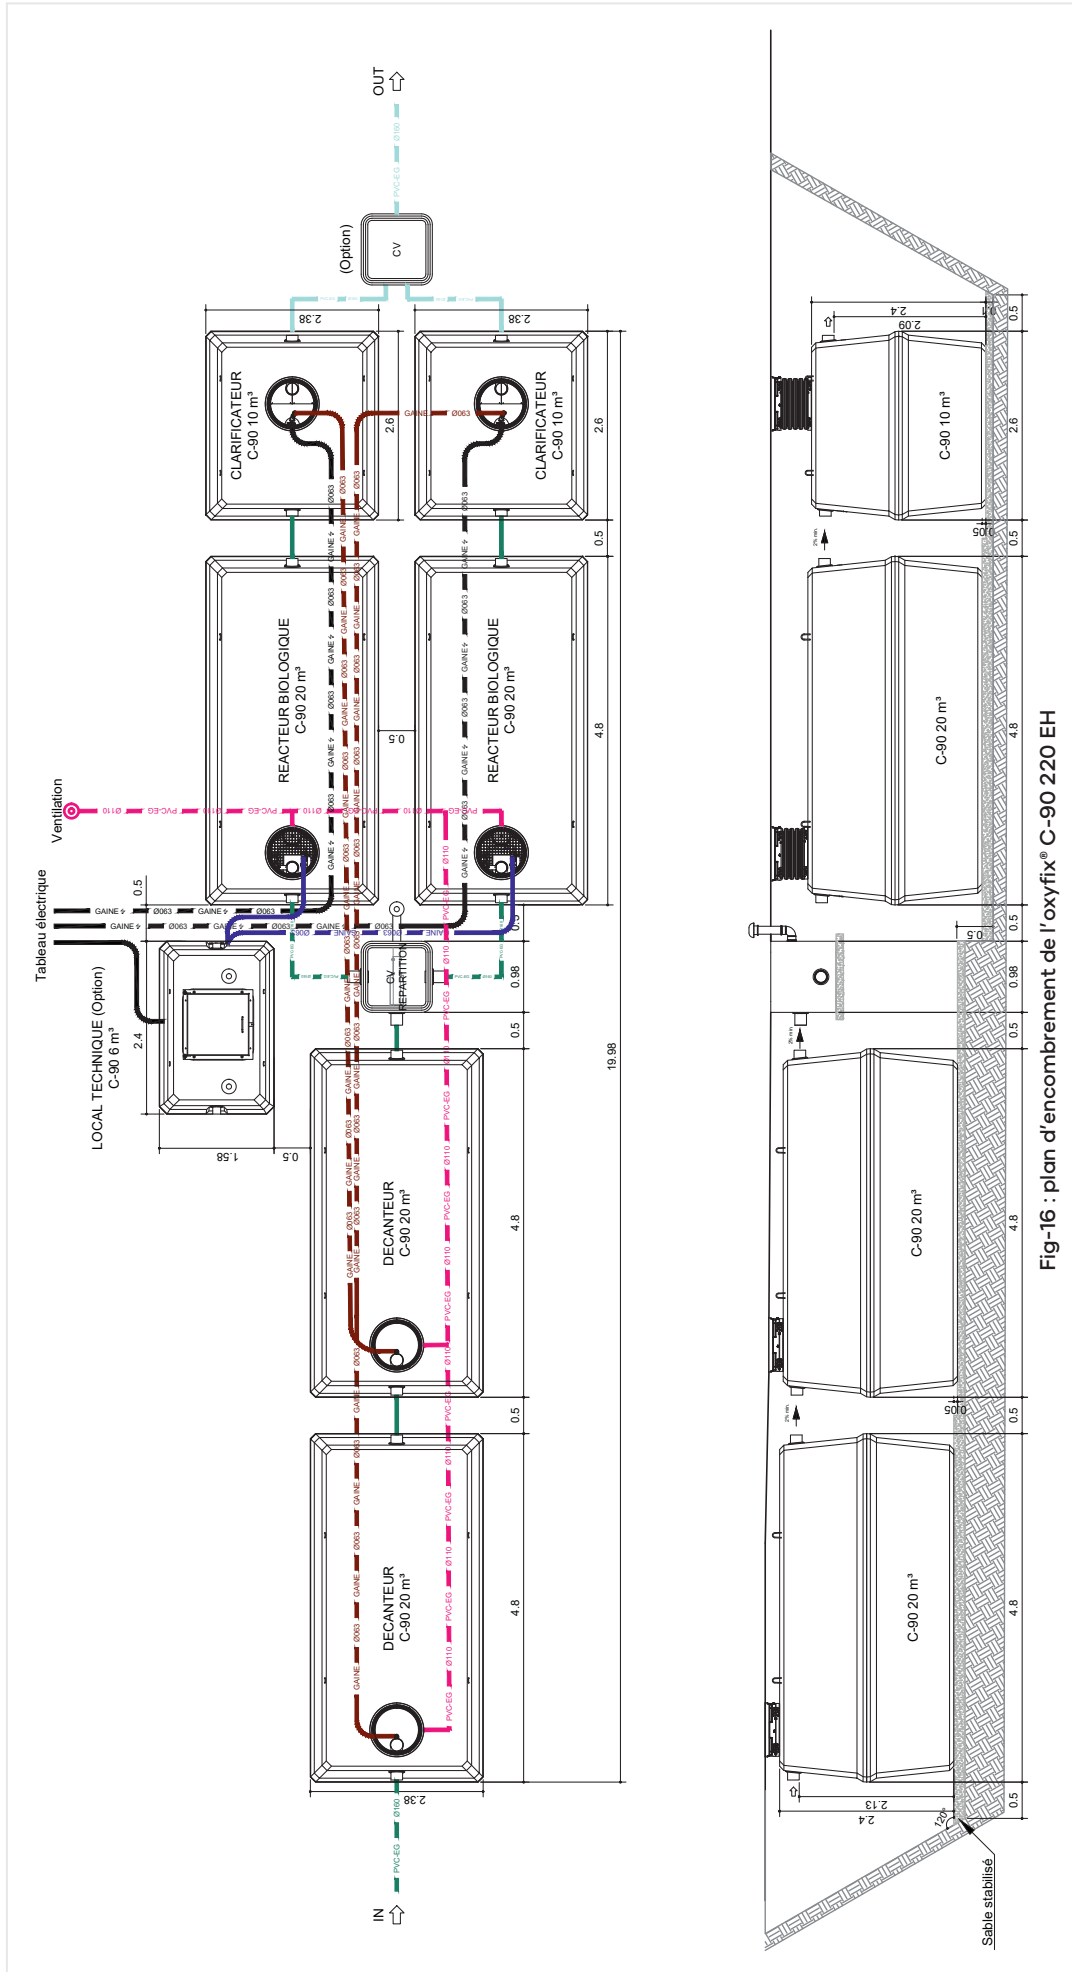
plan d'encombrement de l'oxyfix® C-90 220 EH
